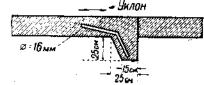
Упор в основании бетонной плиты на крутых уклонах.
